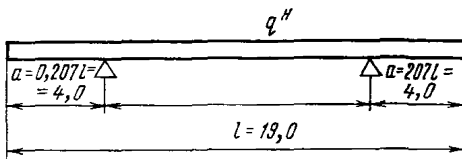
Схема для расчета свай на подъем за две точки со стенда
